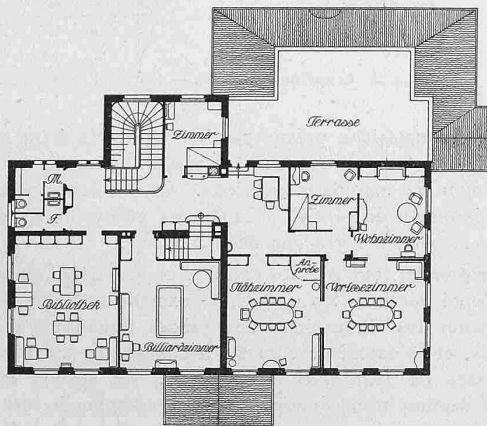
bis 10. Grundrisse, Masstab 1:400,
